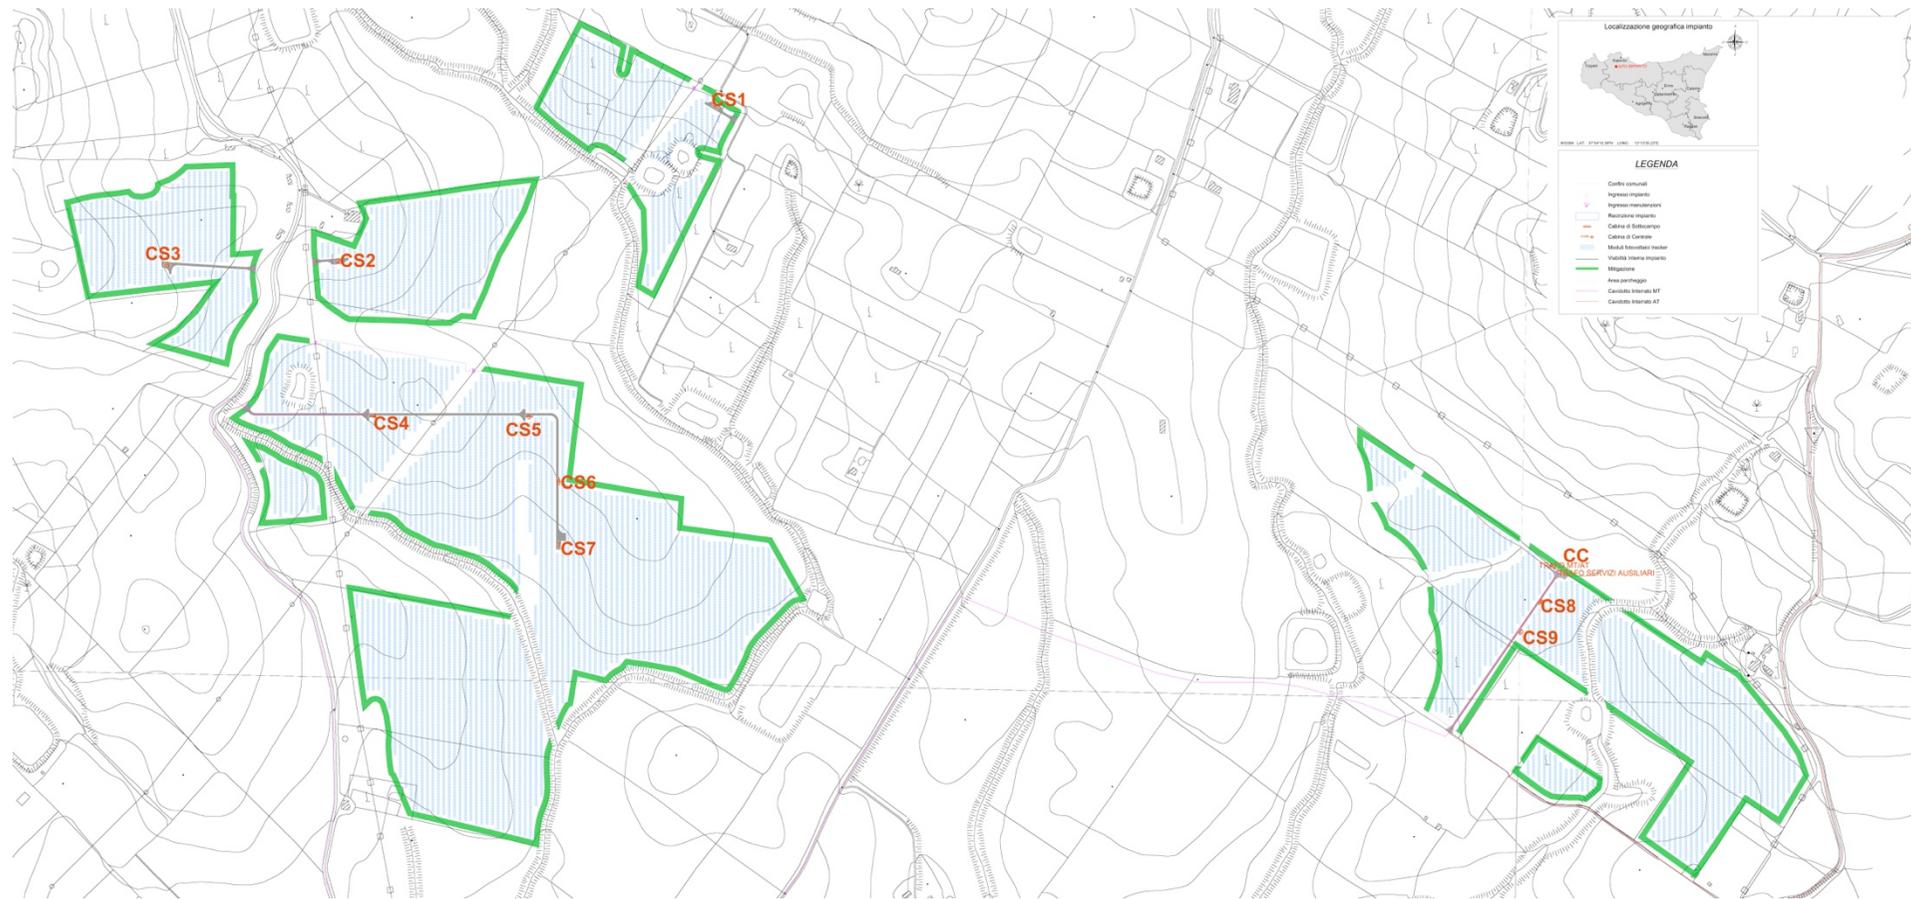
Inquadramento CTR con layout dell’impianto in progetto e identificazione delle cabine di trasformazione
